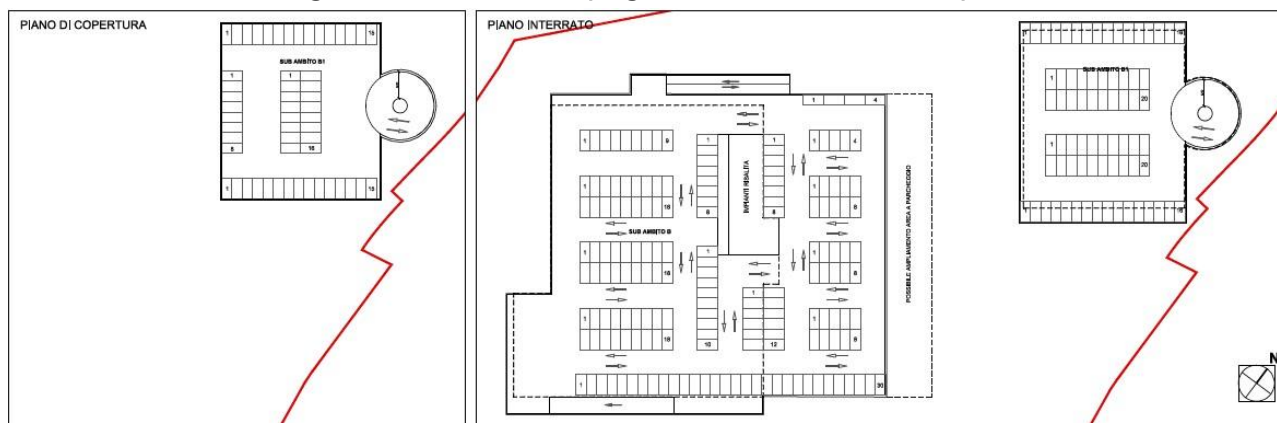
Planimetria di progetto dell'intervento, parcheggi in struttura
